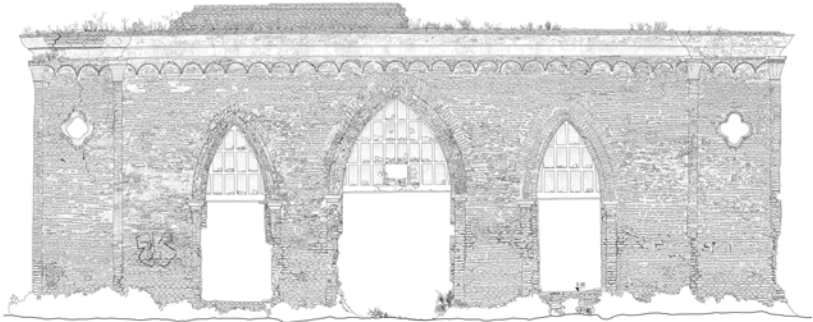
Levantamiento del estado actual de la fachada norte del Molino (C. Palomba)
